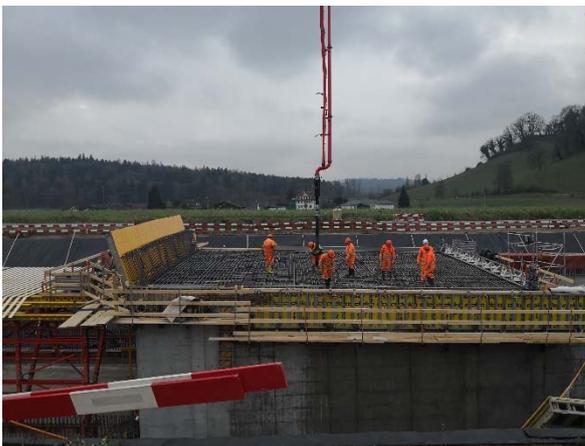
Betonieren der ersten Tunneldecke beim Portal Horner
